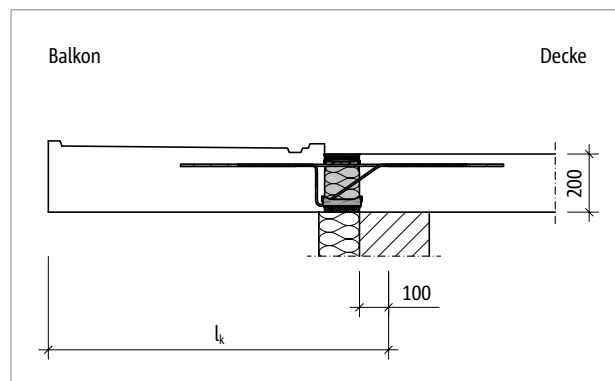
Schöck Isokorb® XT Typ K: Statisches System
